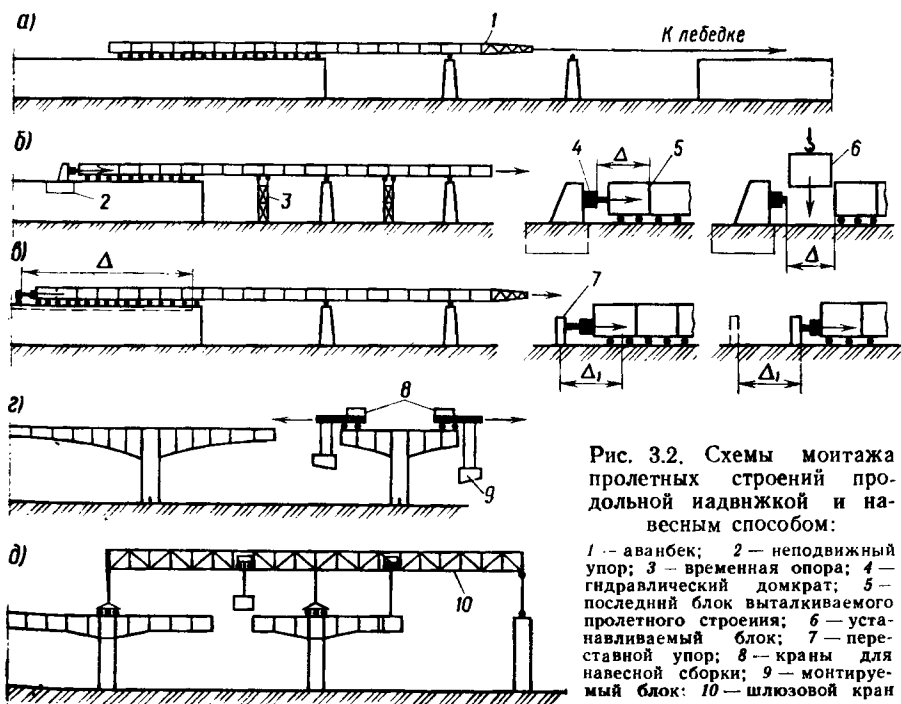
Схемы монтажа пролетных строений продольной надвигкой и навесным способом:
